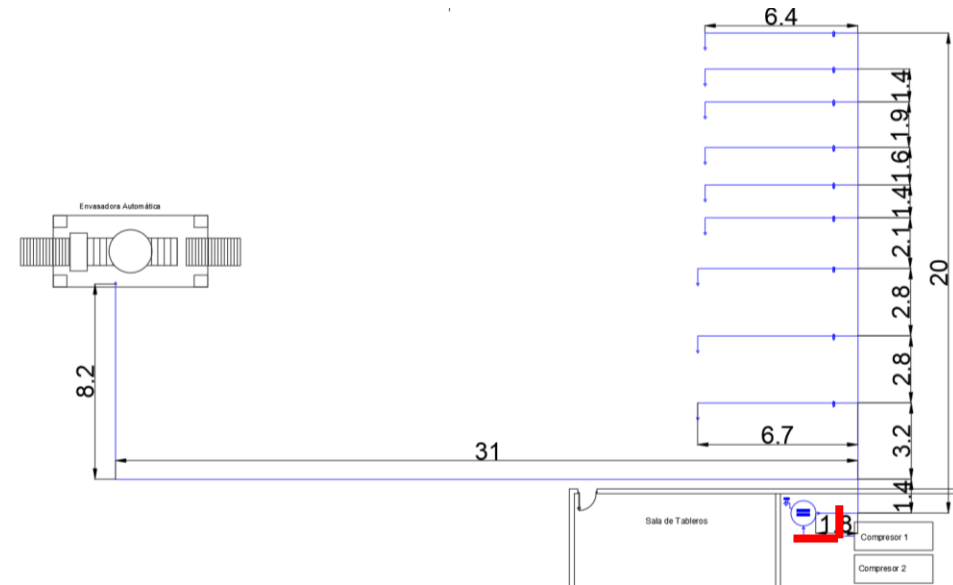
Layout verificación 1 de cañería de aire comprimido
